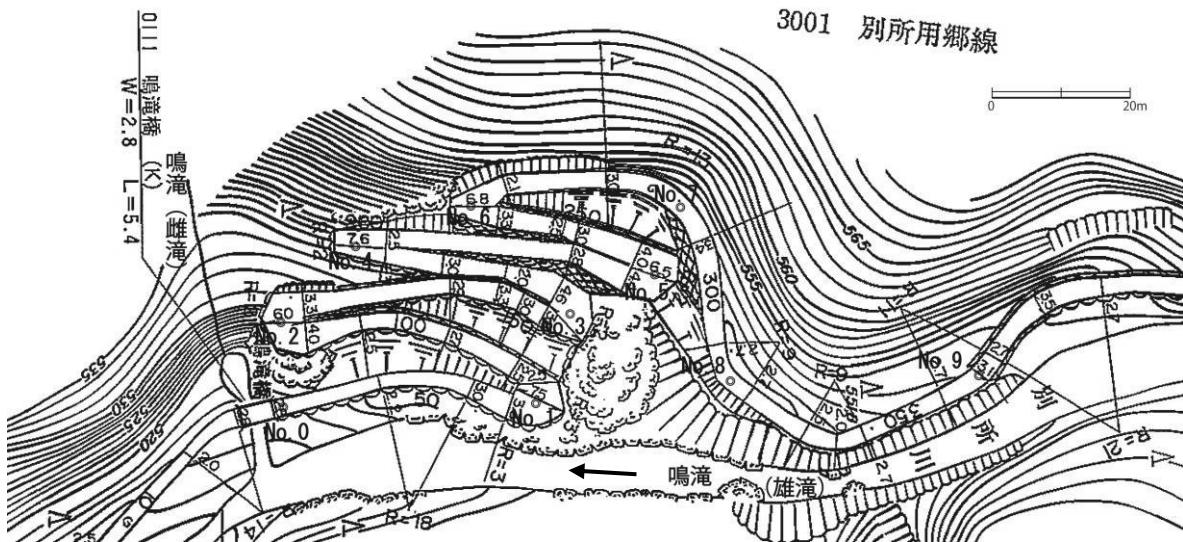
用郷林道“七曲がり”の平面図（新見市提供の平面図に加筆）
